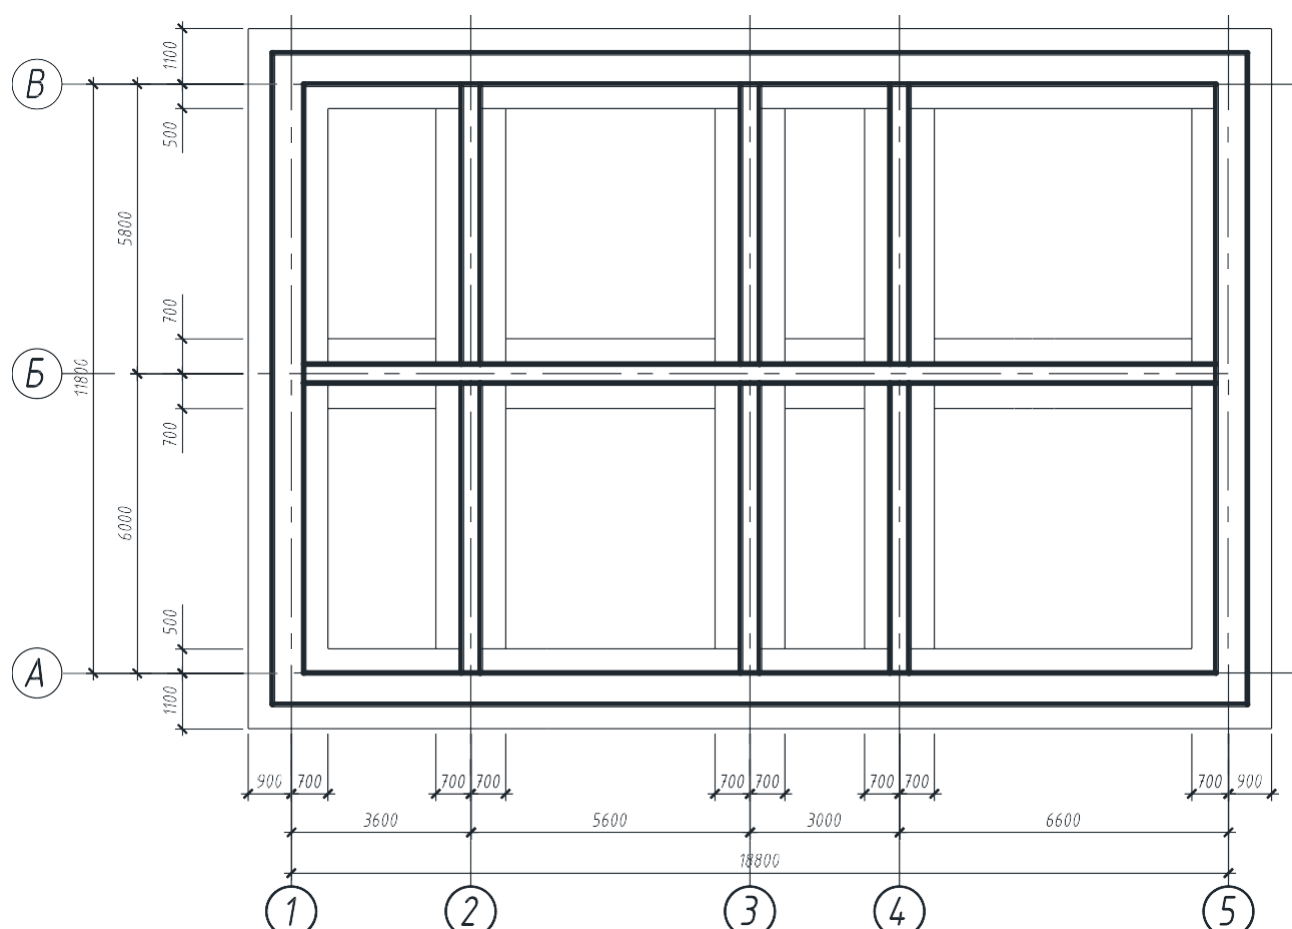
Схема нанесения контуров фундаментных блоков и плит
